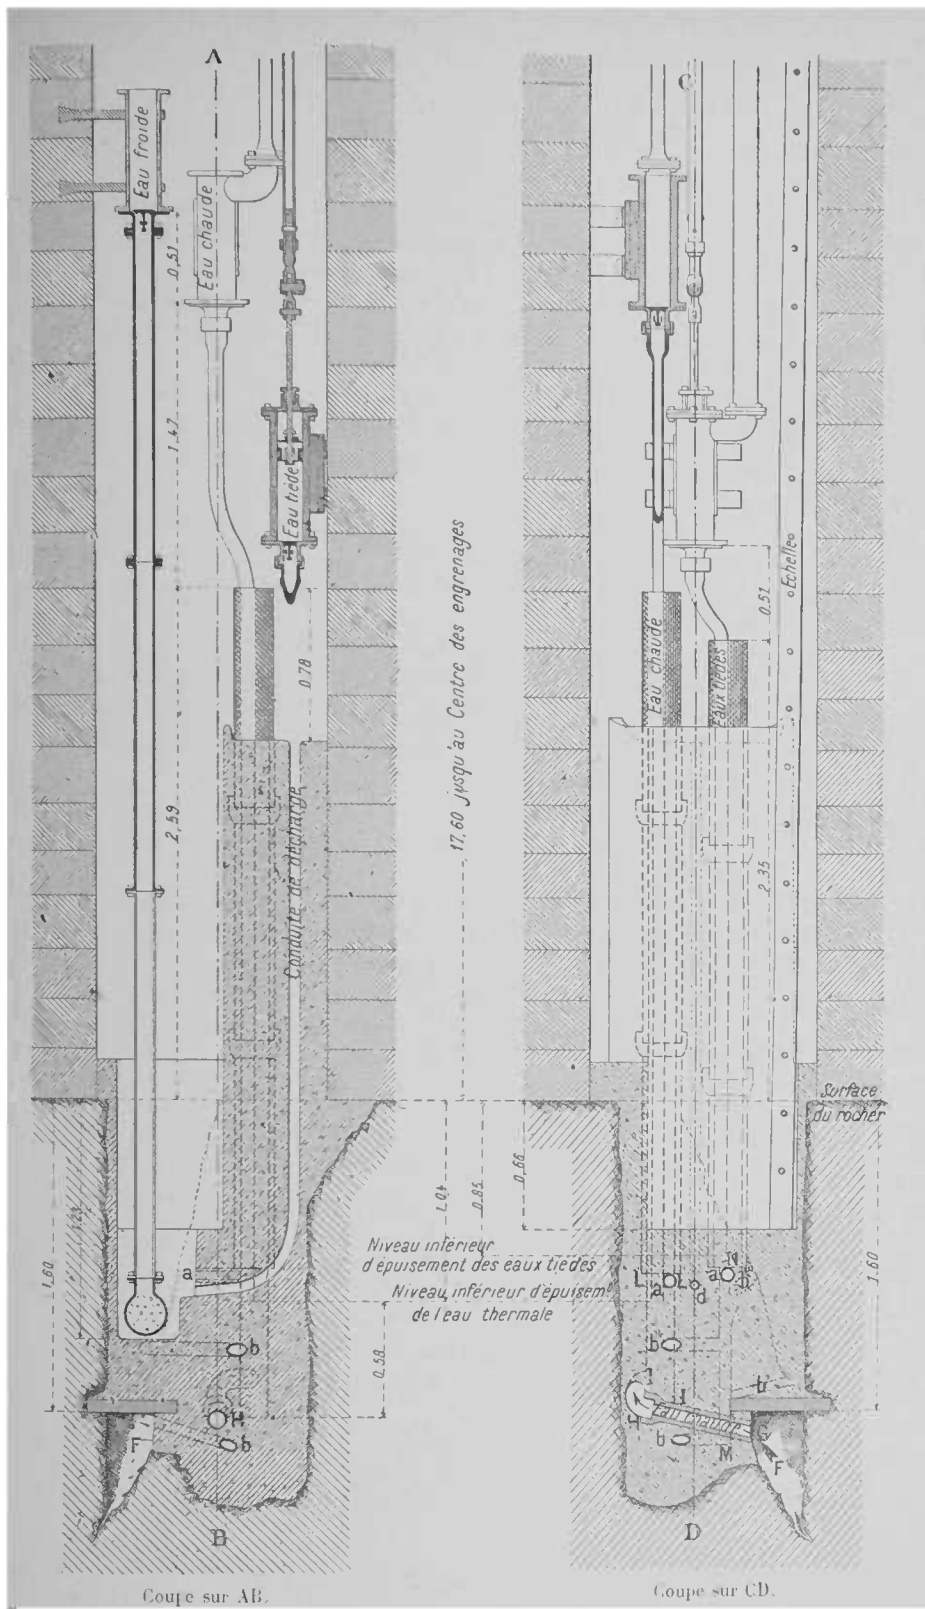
Travaux de captage et transformation du mécanisme du puits de Lavey, exécutés en 1884 par M. Otto Ossant.
